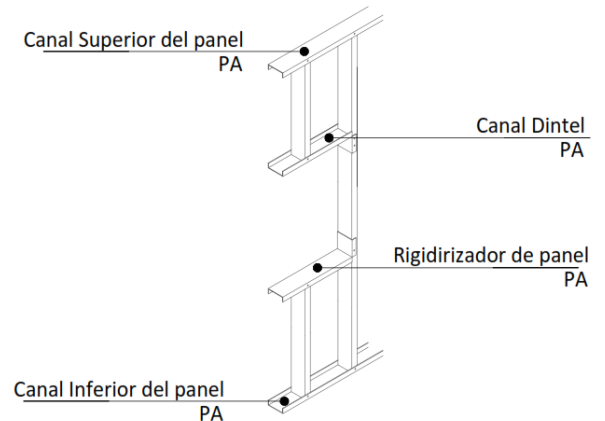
, Fijación de elementos. (Fuente: propia del autor)
